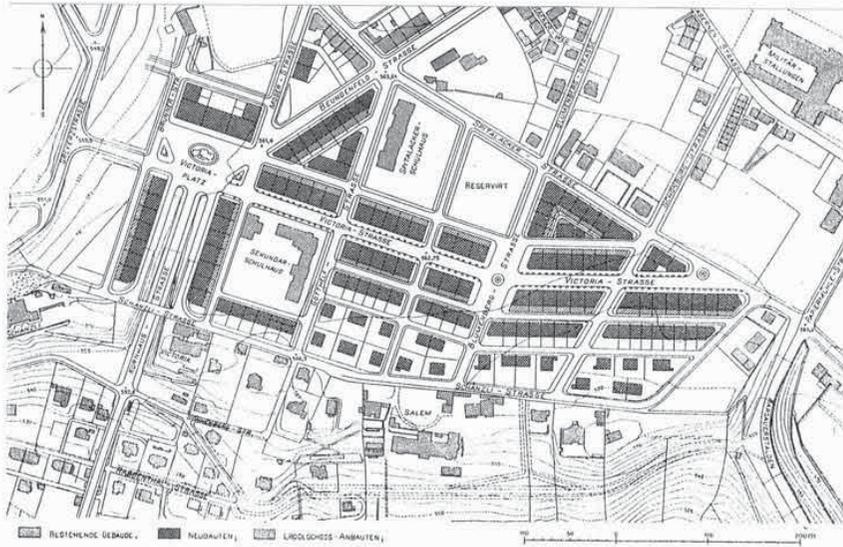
Bebauungsplan Spitalacker, Vorschlag städtische Baudirektion, 1904
